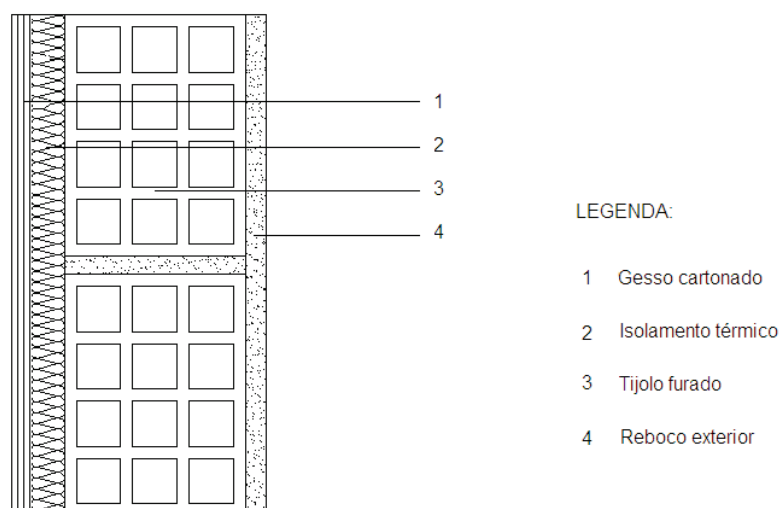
Pormenor construtivo da parede simples com isolamento térmico pelo interior.
